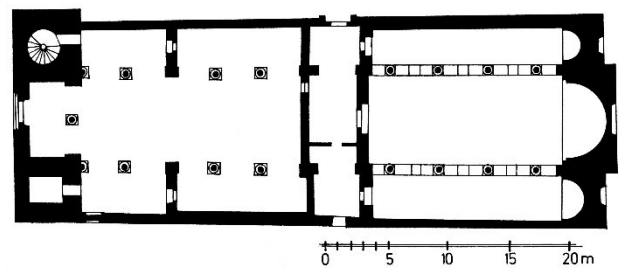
Grundriss der Klosterkirche Bursfelde
